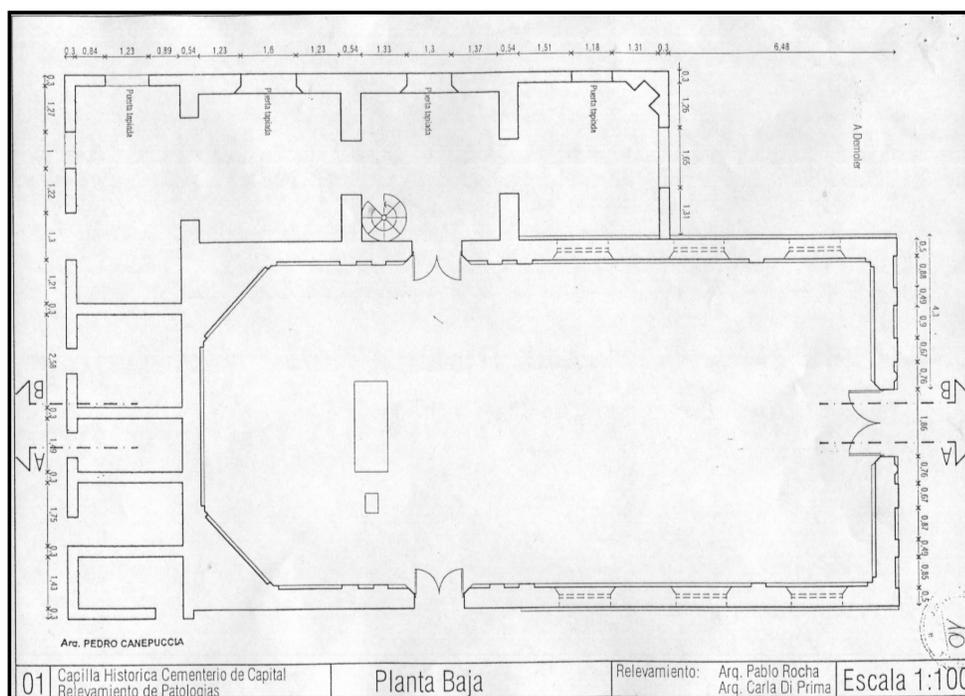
Planta interior de la capilla, (Arquitectos: Rocha y Di Prima)⁵
